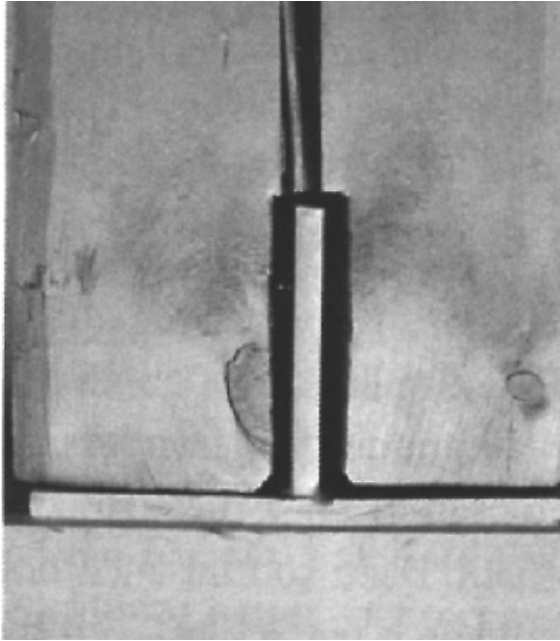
Anschluß eines Deckenbalkens an den Streichbalken (Draufsicht)
